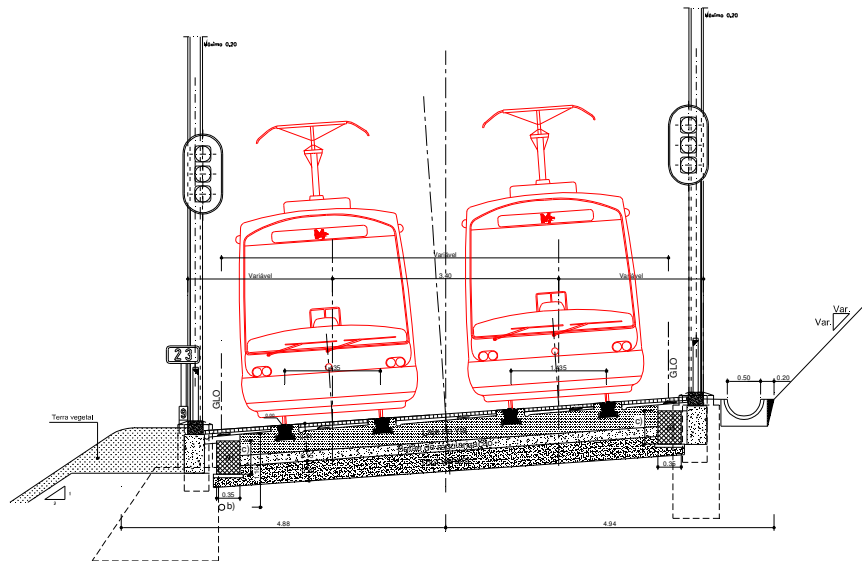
Via dupla betonada, em curva, em zona de aterro/escavação.
